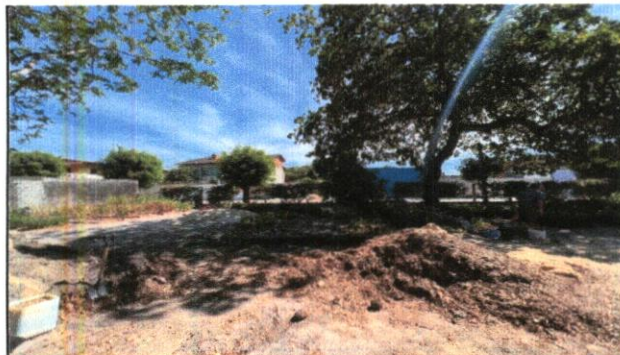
FOTO Nº	AV. JOSÉ LOPES DA SILVA
